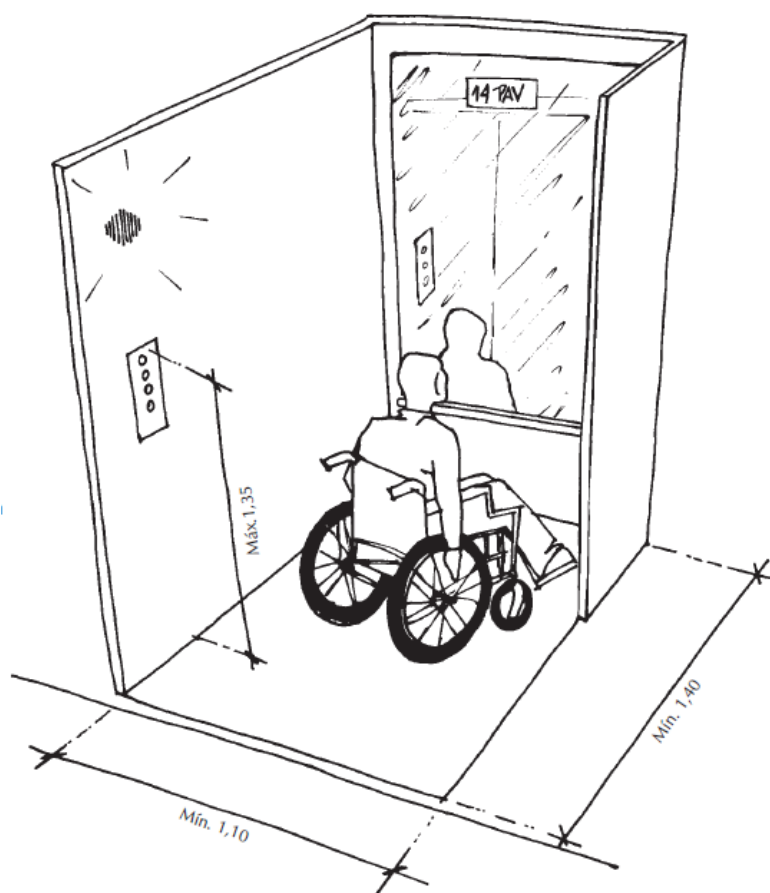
Perspectiva ilustrativa da vista interna do elevador (SMPED, 2008).
